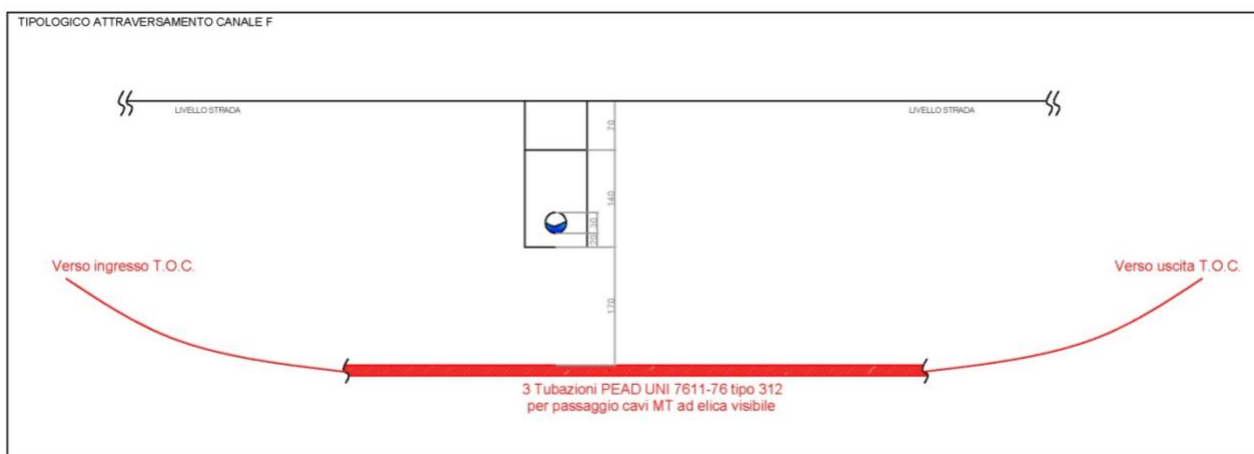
Dettaglio attraversamento in T.O.C. canale F
